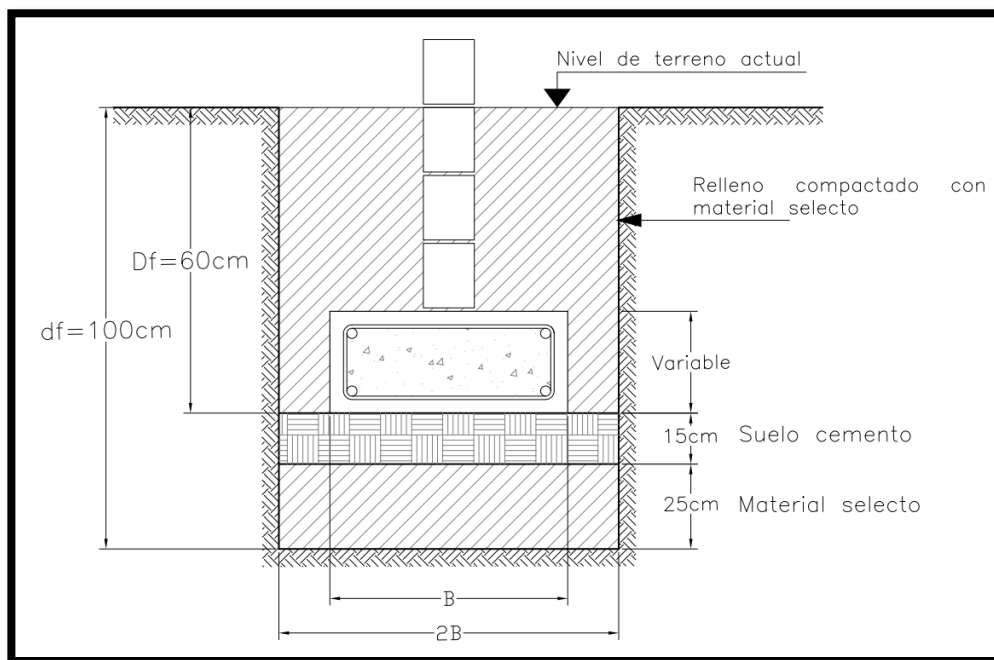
Detalle de propuesta para cimentación y mejoramiento del subsuelo para solera de fundación
